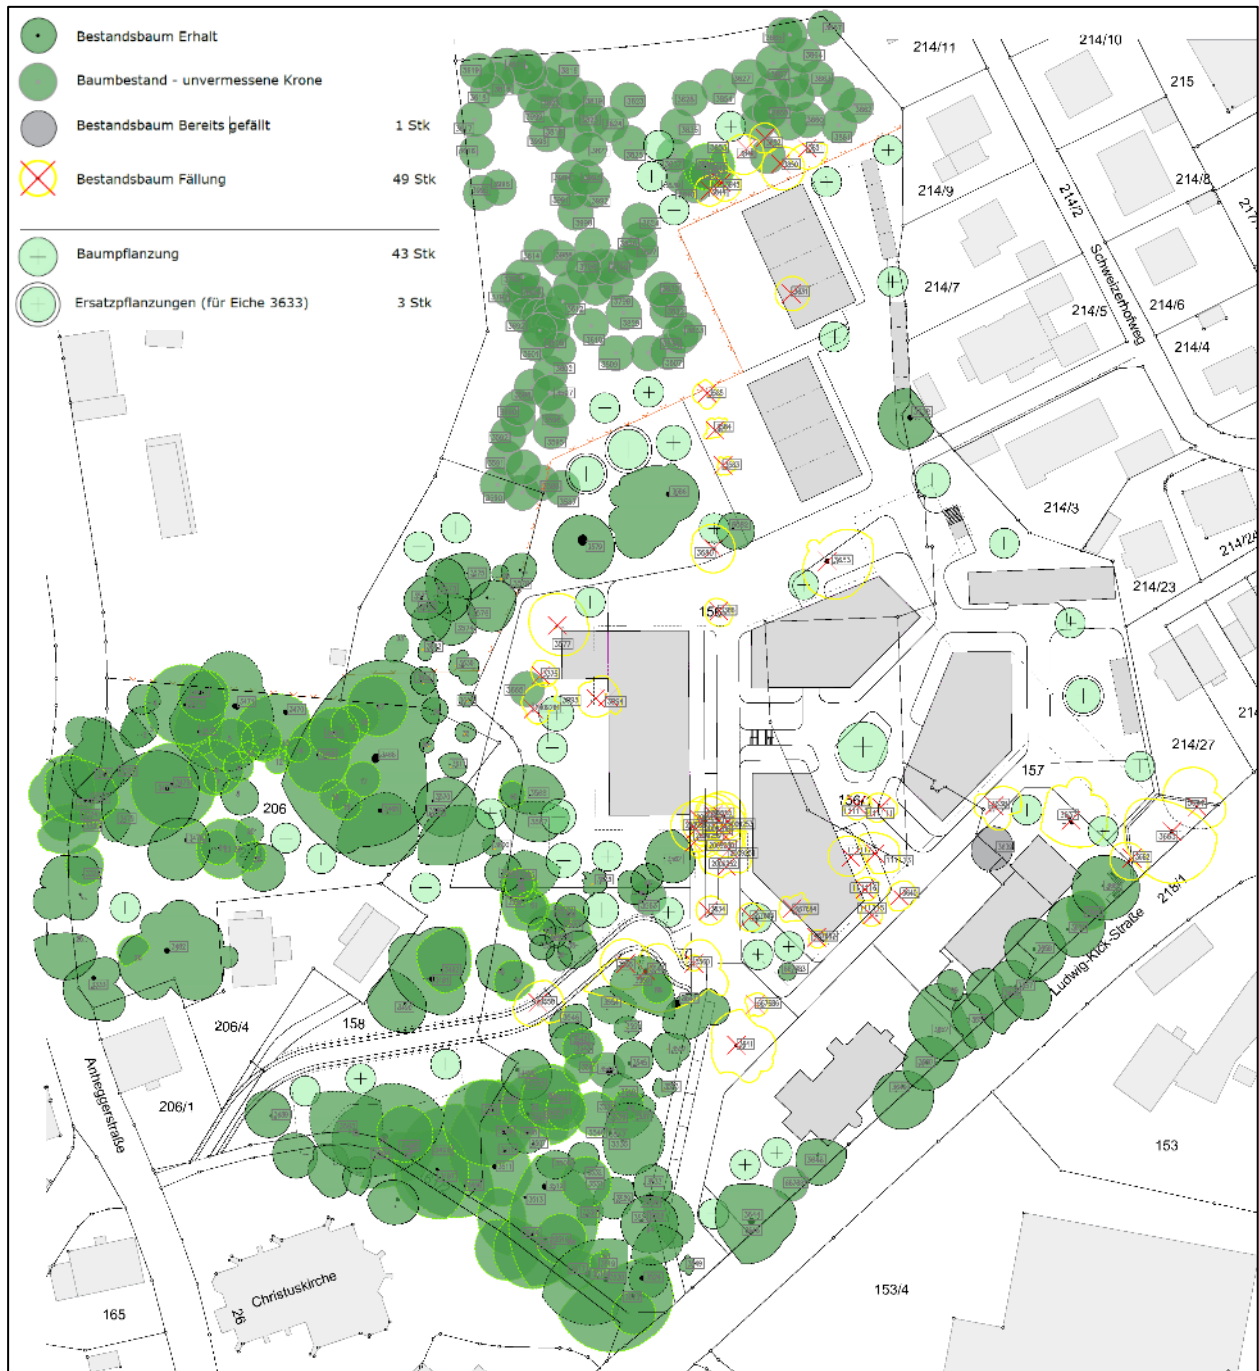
Auszug Baumbilanzplan, Ramboll Deutschland GmbH (Stand:23.04.2024)
